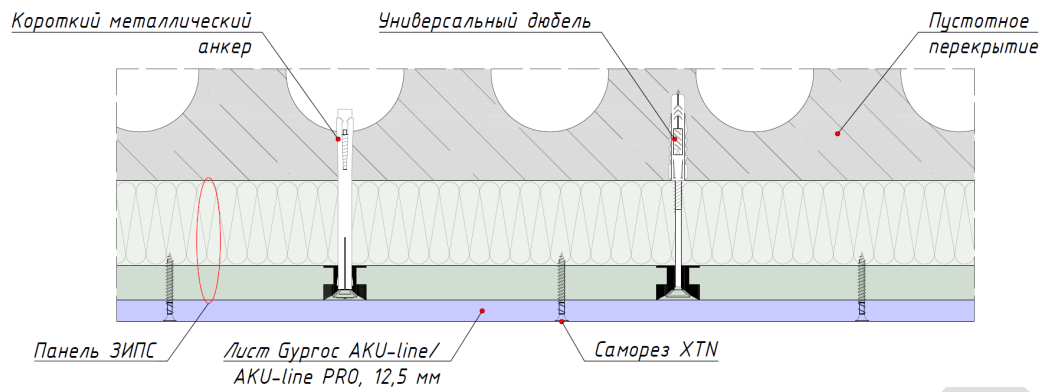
Монтаж панельной системы ЗИПС на пустотное потолочное перекрытие.
